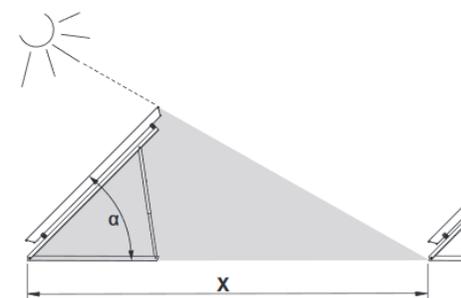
Principe d'implantation des rangées de panneaux solaires
